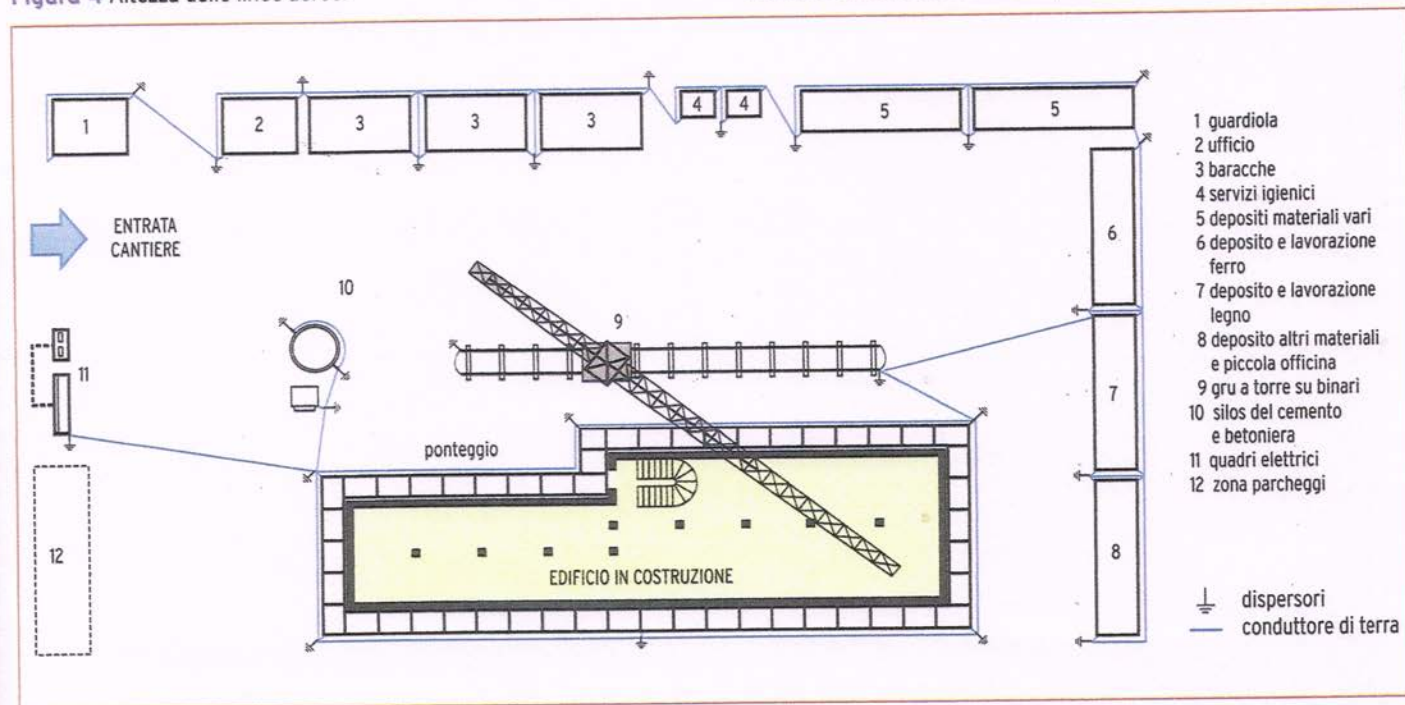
Esempio di allestimento del sistema di protezione e di dispersione di un cantiere.
